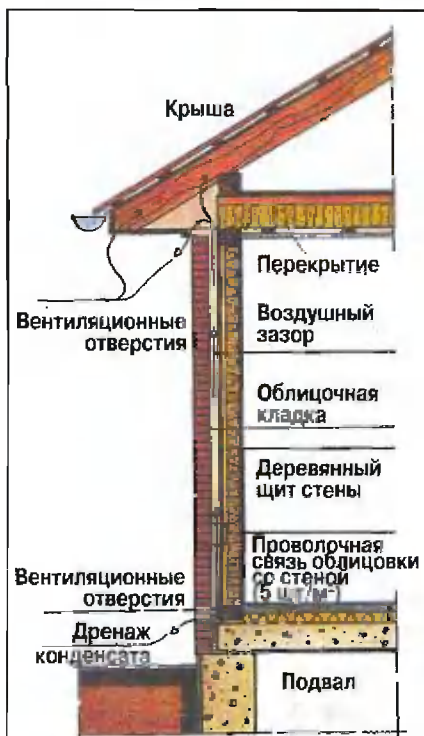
Конструктивная схема наружной стены сборного дома с циркуляцией воздуха между несущей стеной и облицовочной кирпичной кладкой
